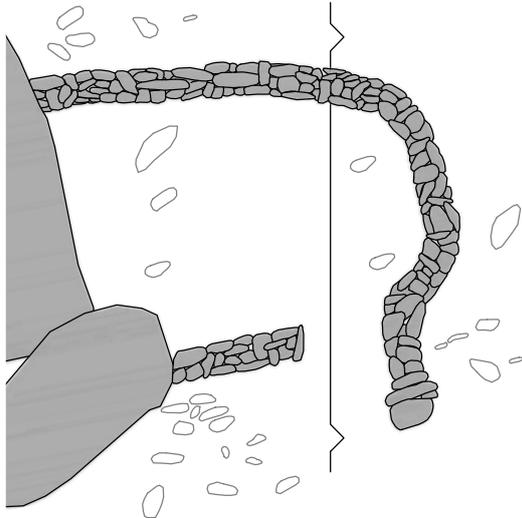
Planta del casal de Vallancho en Bermillo de Sayago. Fuente: Elaboración propia.
